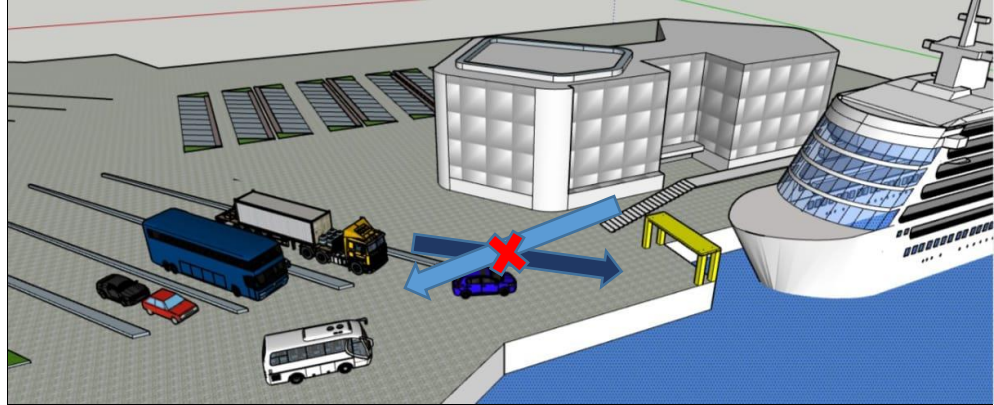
Kondisi Eksisting Lapangan Parkir.
